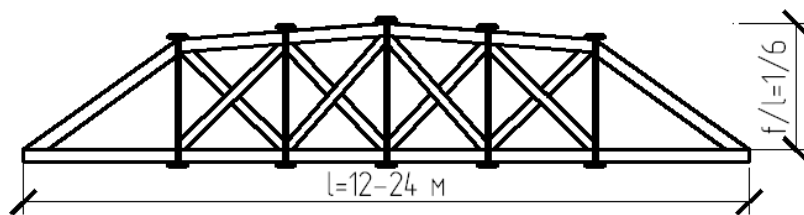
Пятиугольная ферма из брусьев или бревен на лобовых врубках.
